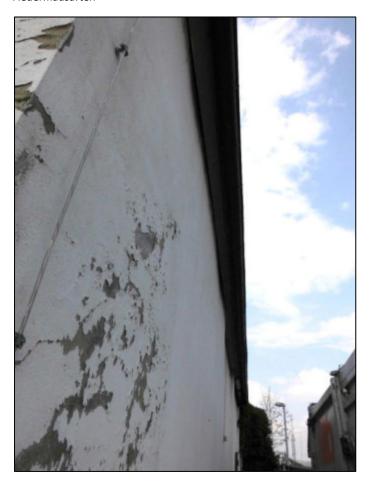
Kleine Lagerhalle - Einflugmöglichkeit über die Attikaverblechung
